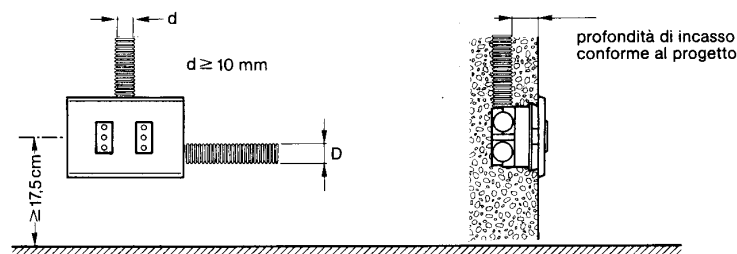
Criteri di installazione degli impianti incassati e similari
